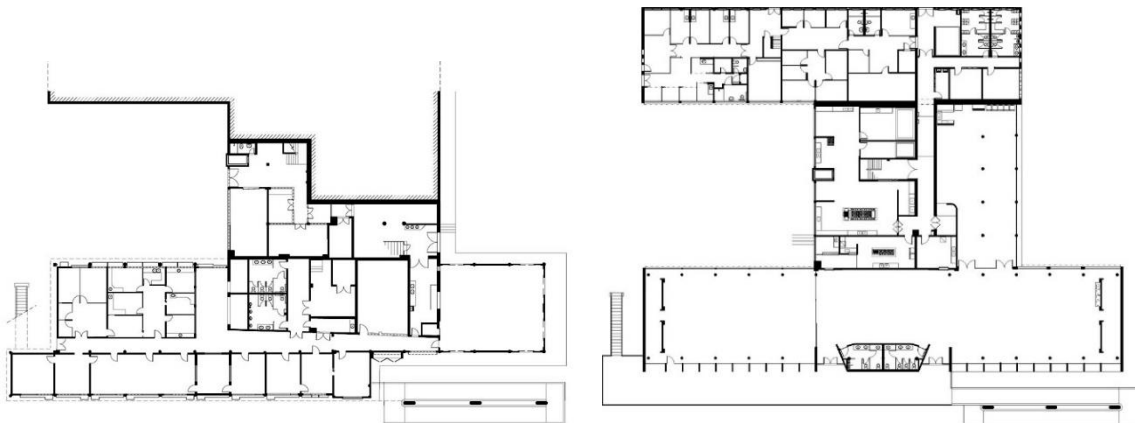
Pav. Carlo Augutso da Silva: planta baixa do pavimento inferior, 2016. Fonte: DPH/COC/Fiocruz
